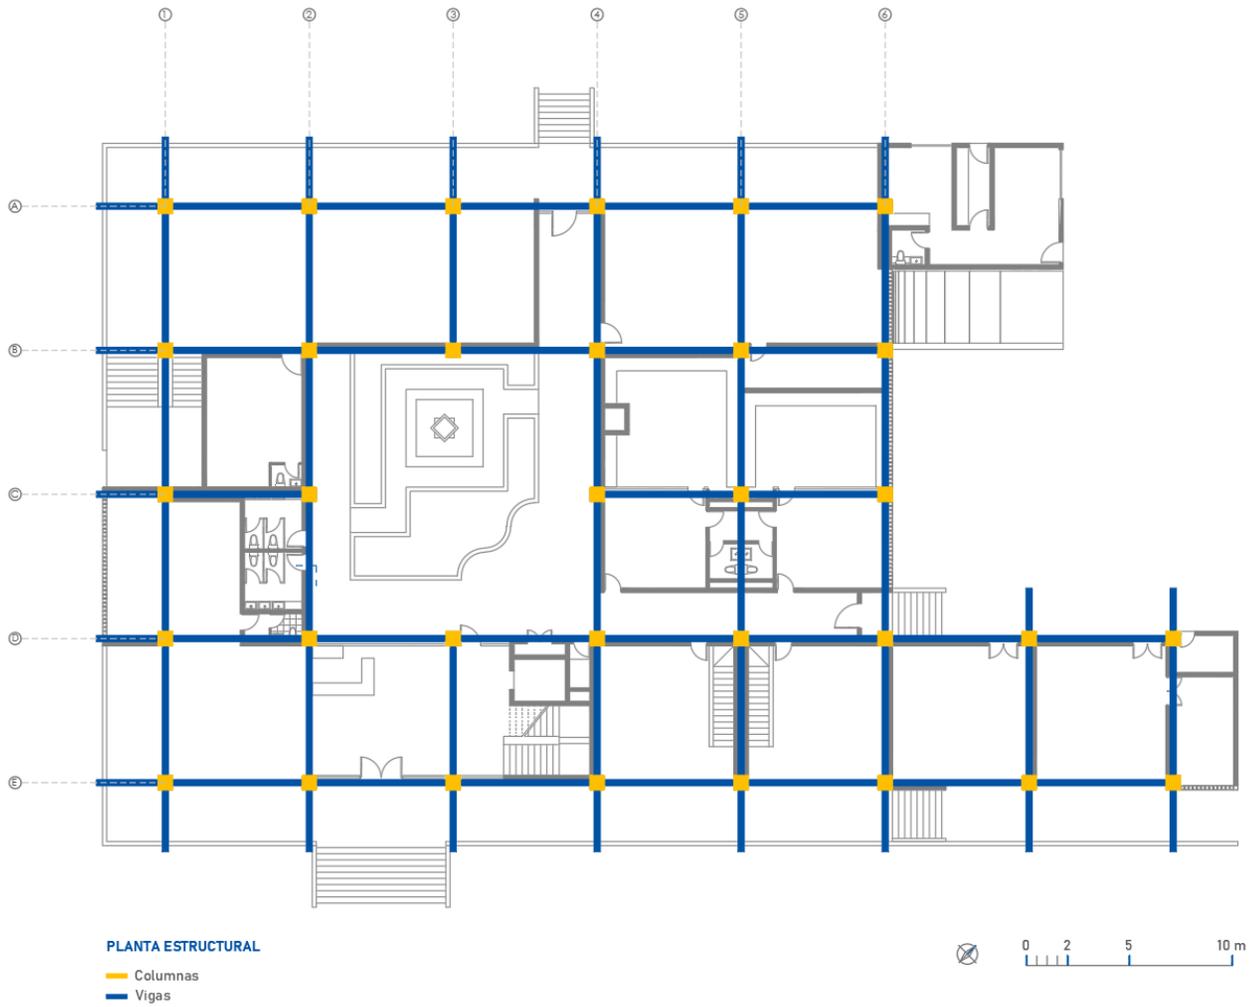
| Distribución de sistema estructural planta baja. Elaboración propia, 2021.
